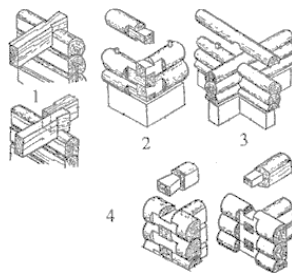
Угловые соединения бревен: 1 —соединение бревна с балкой перекрытия; 2 – в «лапу», 3 – в «чашу»; 4 – соединение внутренней стены с наружной.
